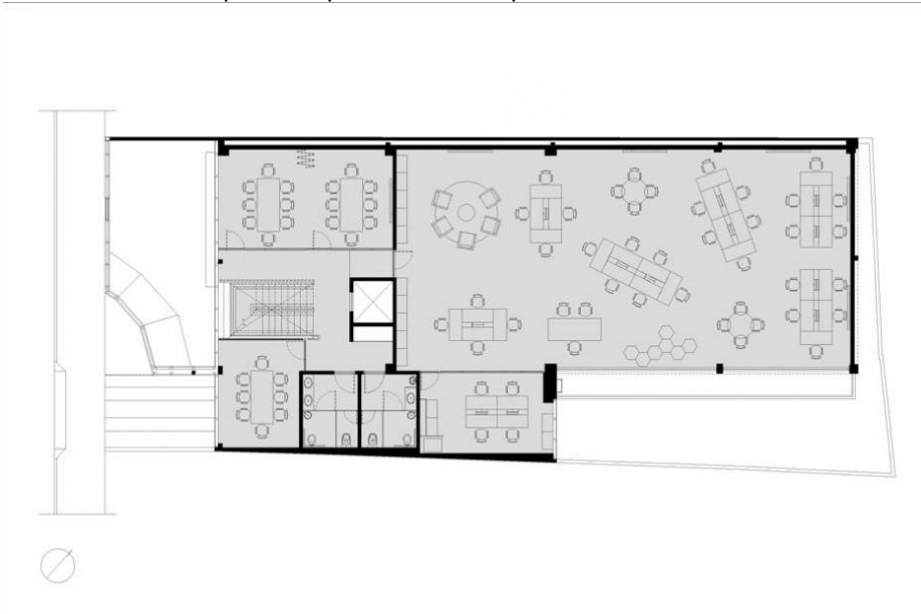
Jump Brasil, planta baixa pavimento térreo.
